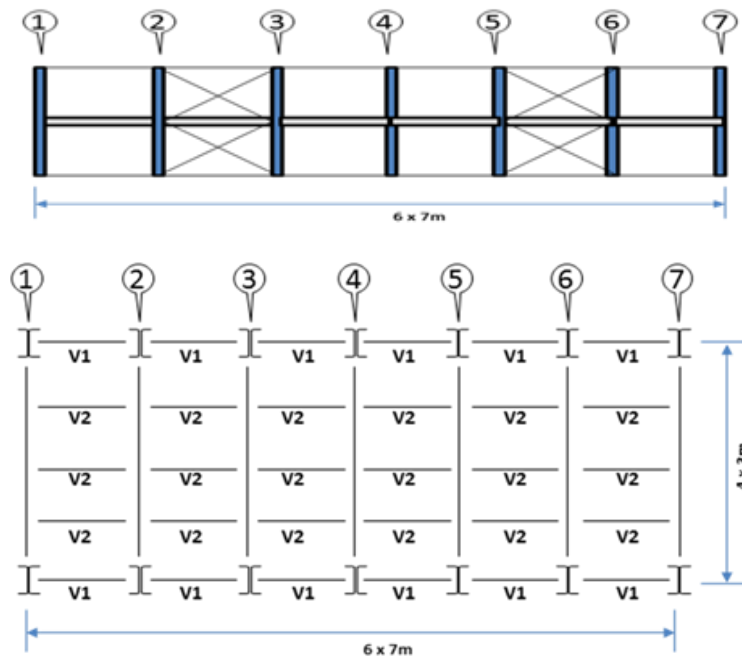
Fachadas laterais e detalhes do piso 2º pavimento
